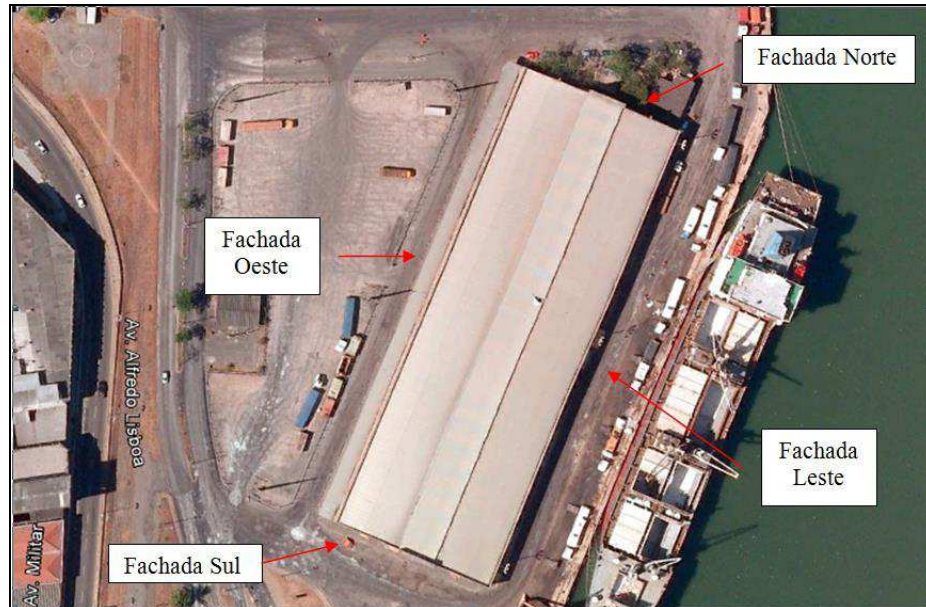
Representação das quatro fachadas do Armazém 6.
